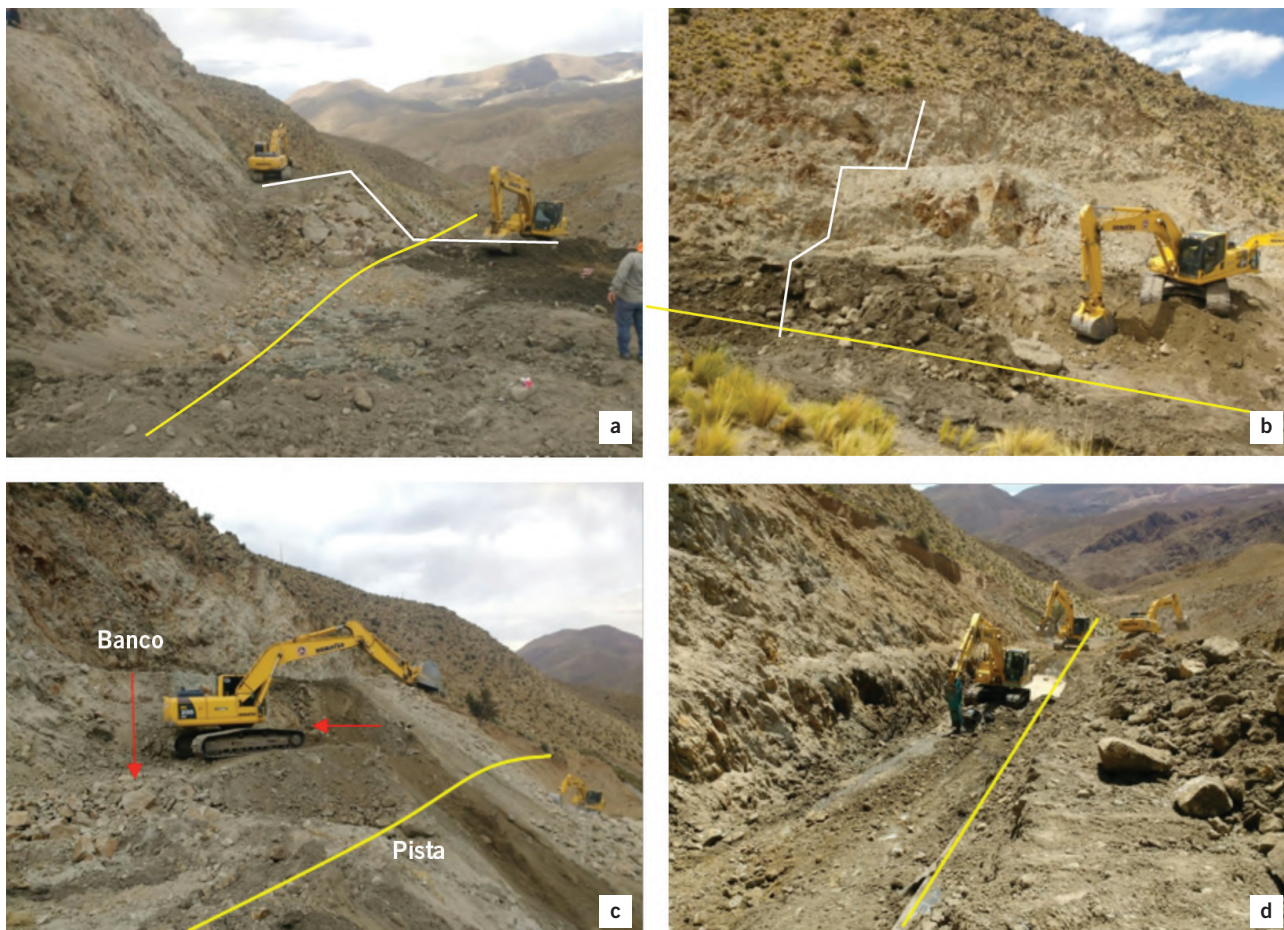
a. Excavadora construyendo el banco en su inicio, a la derecha otra excavadora acondiciona la pista. b. Nivelación de la pista mediante la quita de tapada. c. Comienzo de la excavación lateral del macizo en sus primeros 4 m de altura, por encima el escalón de la etapa 1. d. Extremo este de la excavación para descubrir la tubería y rotura de bloques enterrados con martillo percutor.
